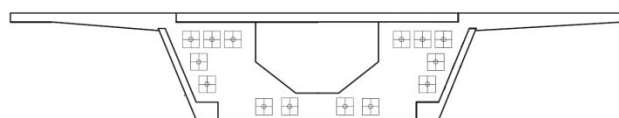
Exemplo de aduela sobre pilar com dispositivo de ancoragem.
